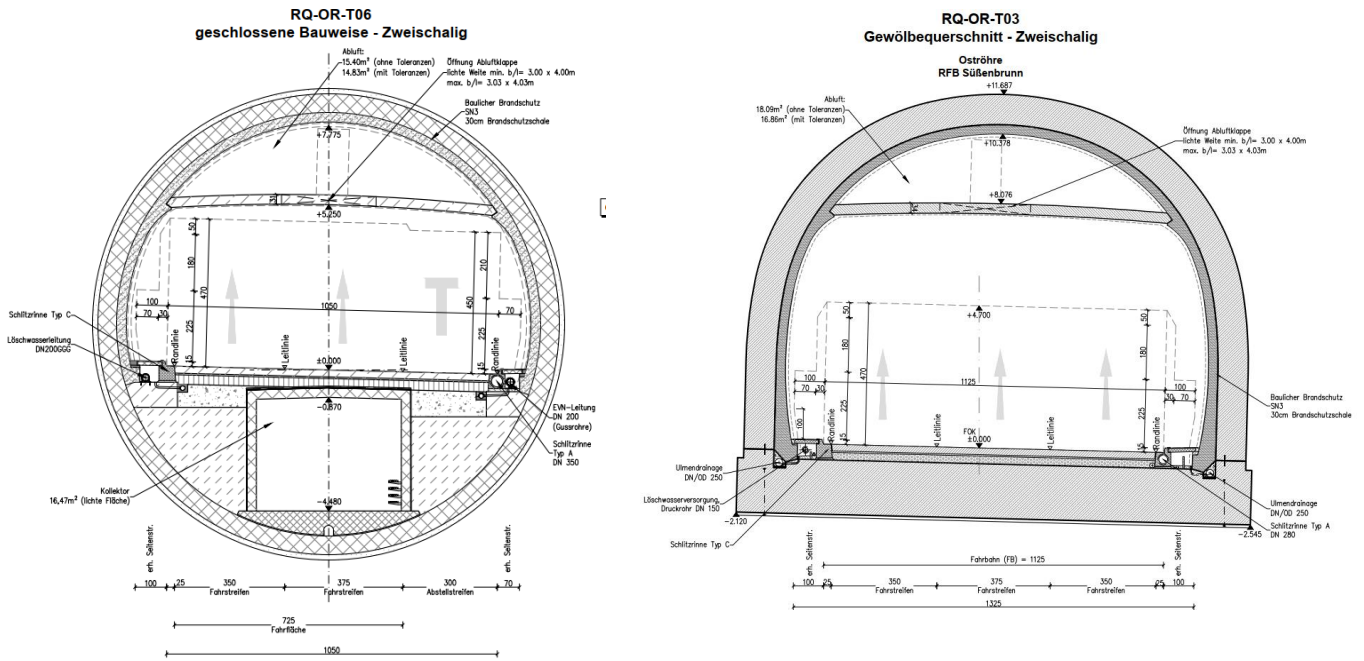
RQ Tunnel Donau-Lobau geschlossene und offene Bauweise
